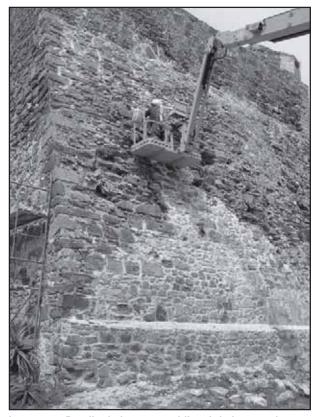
Detalle de la cara meridional de la torre durante la ejecución de los trabajos de consolidación.
